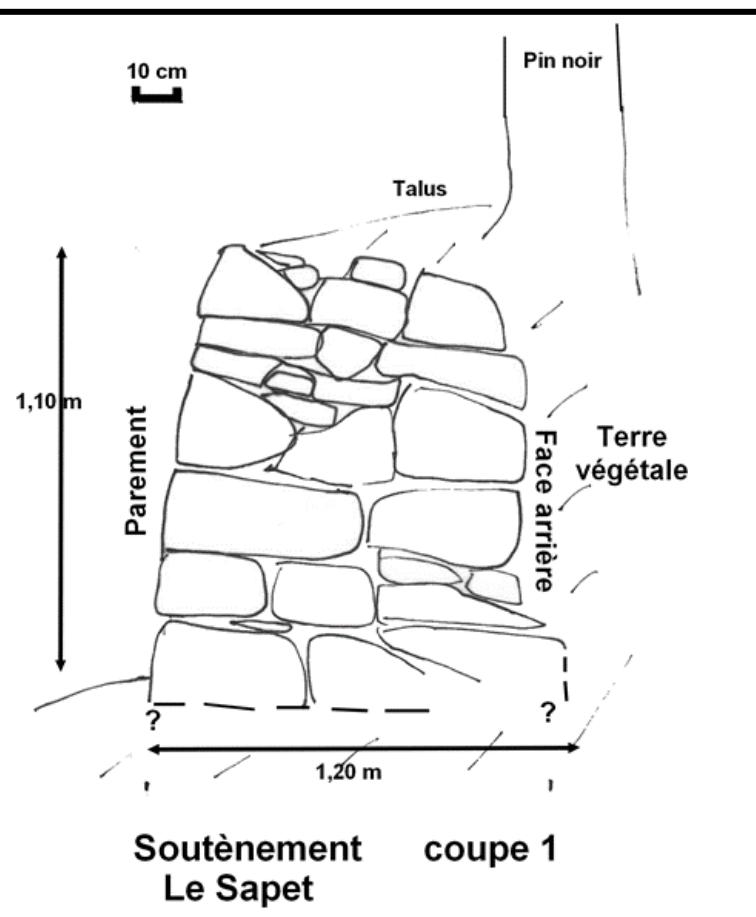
vue en coupe du mur- (croquis Esteban Auzende, fabien Plazy, Tony barreault).
